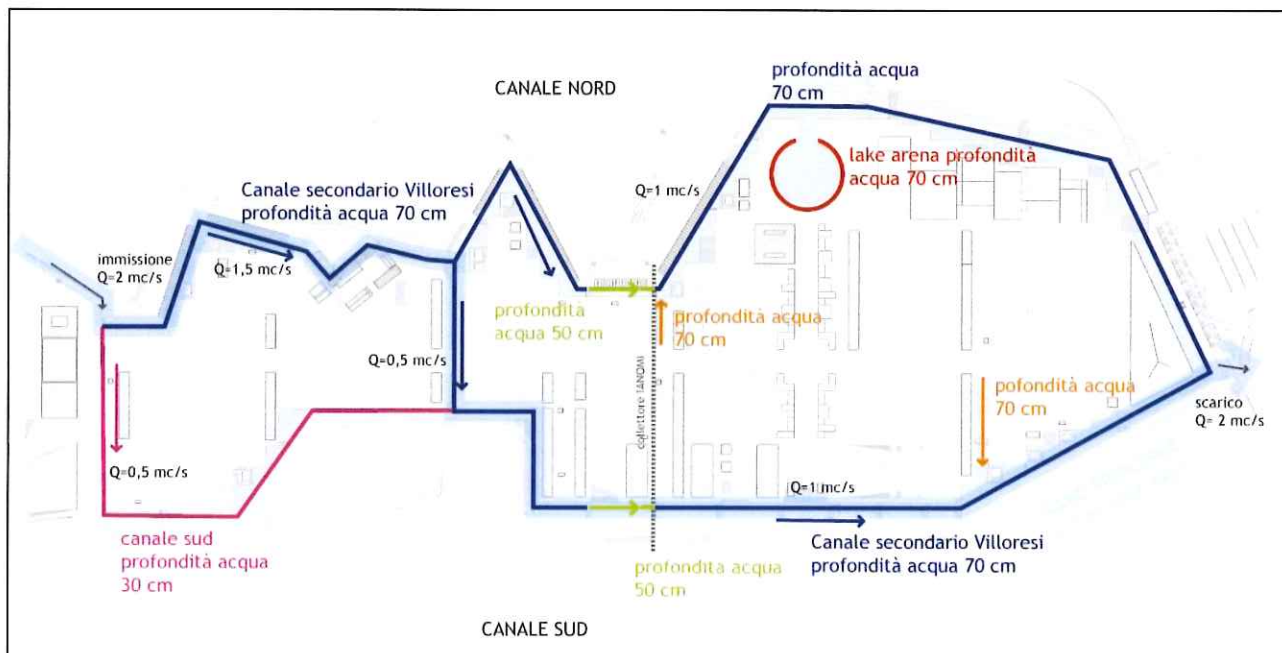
Schema planimetrico del funzionamento del Canale perimetrale durante Expo
